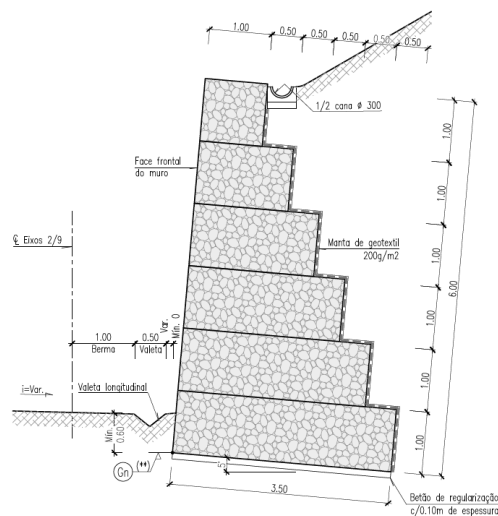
Corte transversal tipo do muro M2 (Muro de Gabiões).
